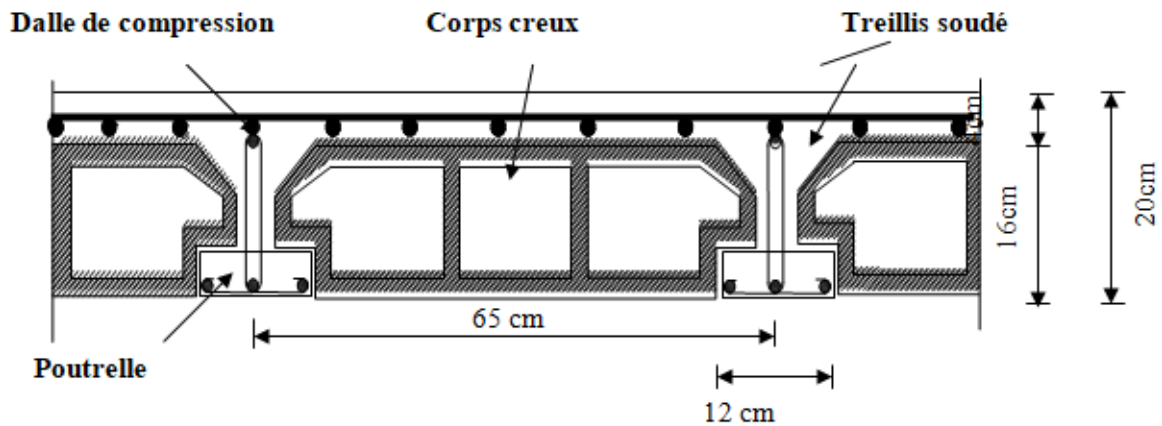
Coupe transversale d'un plancher en corps creux.
